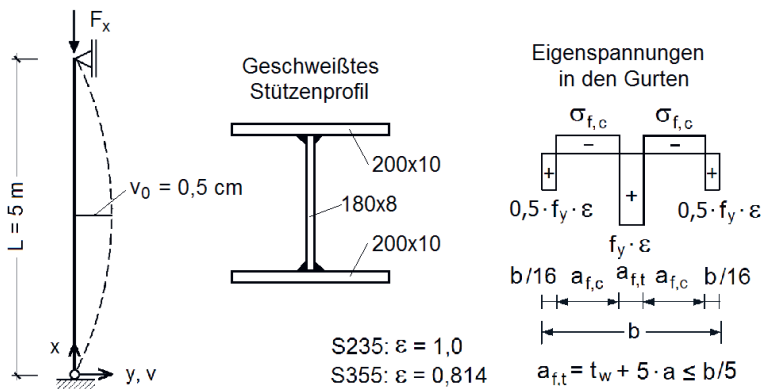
Stütze aus einem geschweißten I-Profil (ca. HEA 200)
